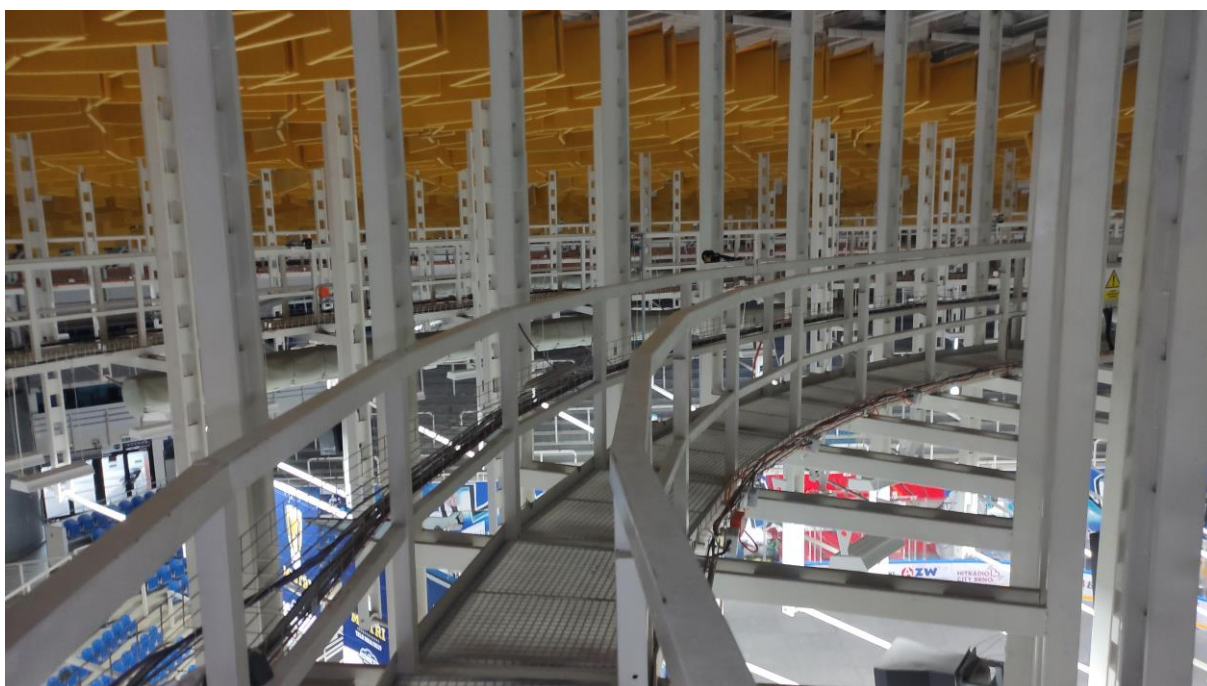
Pohled na revizní a obslužnou lávku pod střechou
